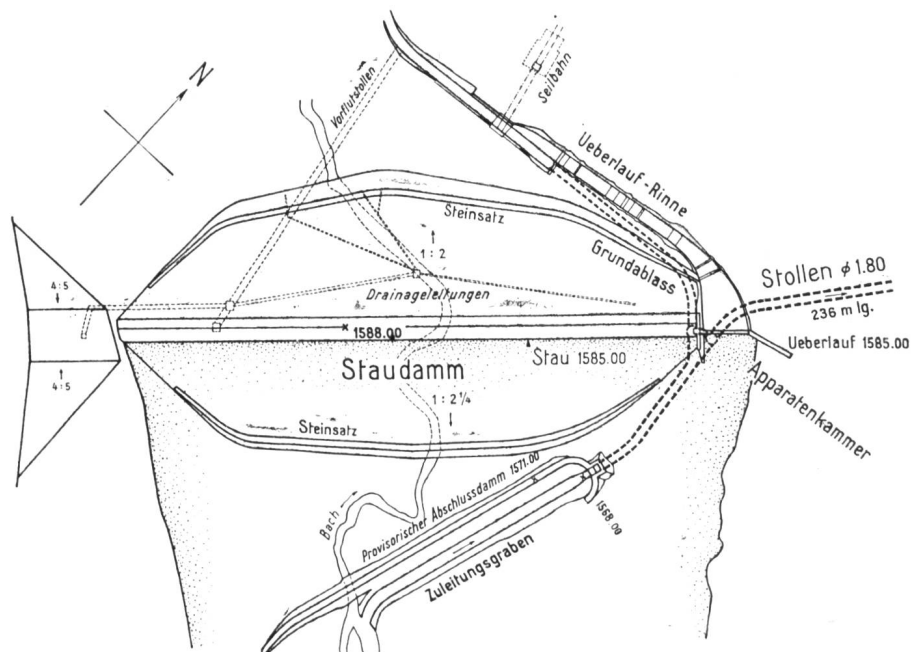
Bannalpwerk, Grundriss des Staudammes, Maßstab 1:2500.
